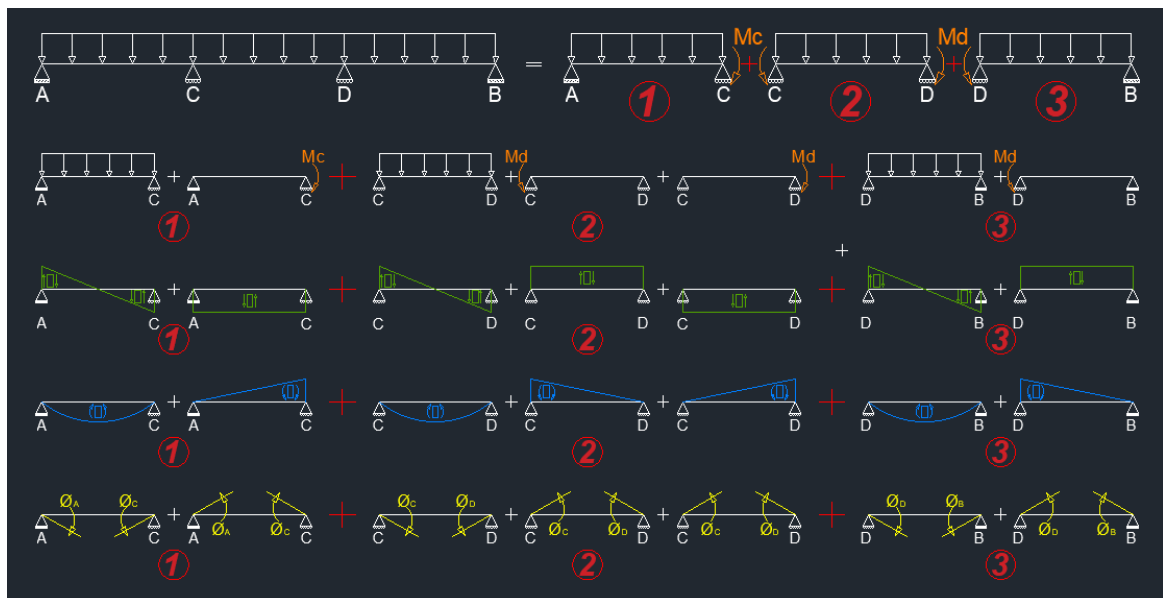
Planteamiento y resolución del Dimensionamiento 3.
